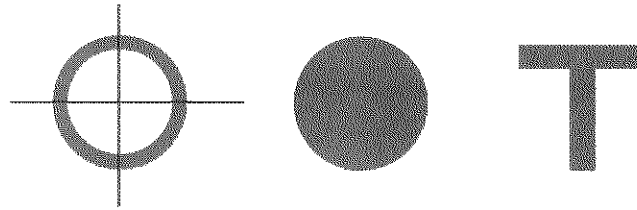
Exemplos de seções transversais de um elemento de barra.
